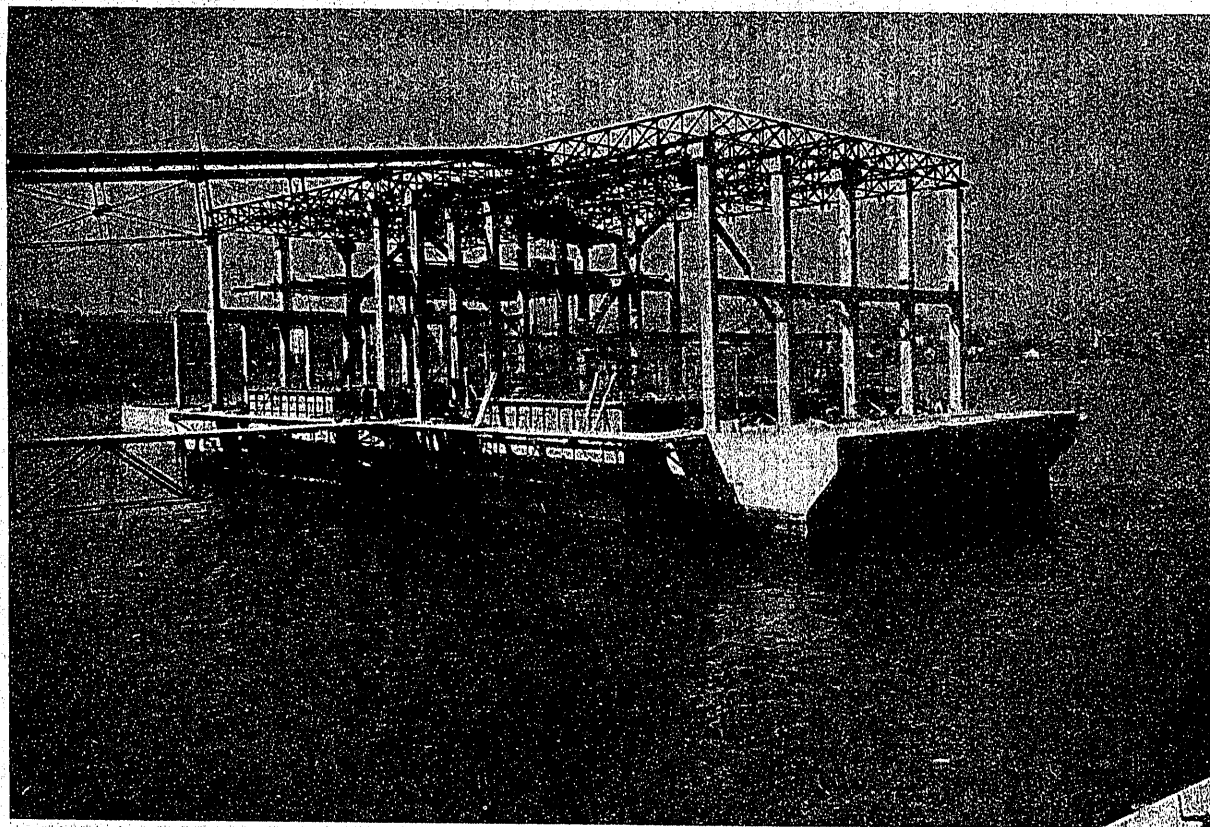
Taller de construcción de cajones. Entre los tres cajones fondeados hay dos plataformas metálicas suspendidas, encima de las cuales se vierte el hormigón. A medida que el hormigonado avanza (llevado a obra por una cinta transportadora y un sistema de canaletas) se hacen descender las plataformas, y cuando la ejecución termina, los cajones flotan y son remolcados fuera del taller. Tanto los encofrados metálicos como las canaletas están suspendidos de la superestructura metálica del taller.
